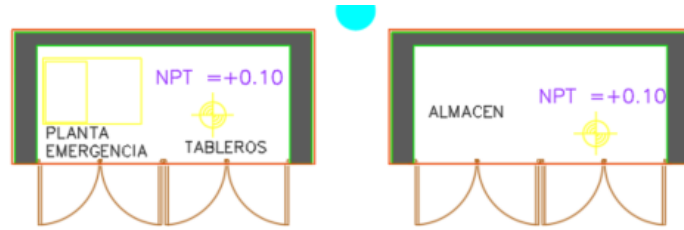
Plano con la ubicación de las plantas de emergencias y almacén.
